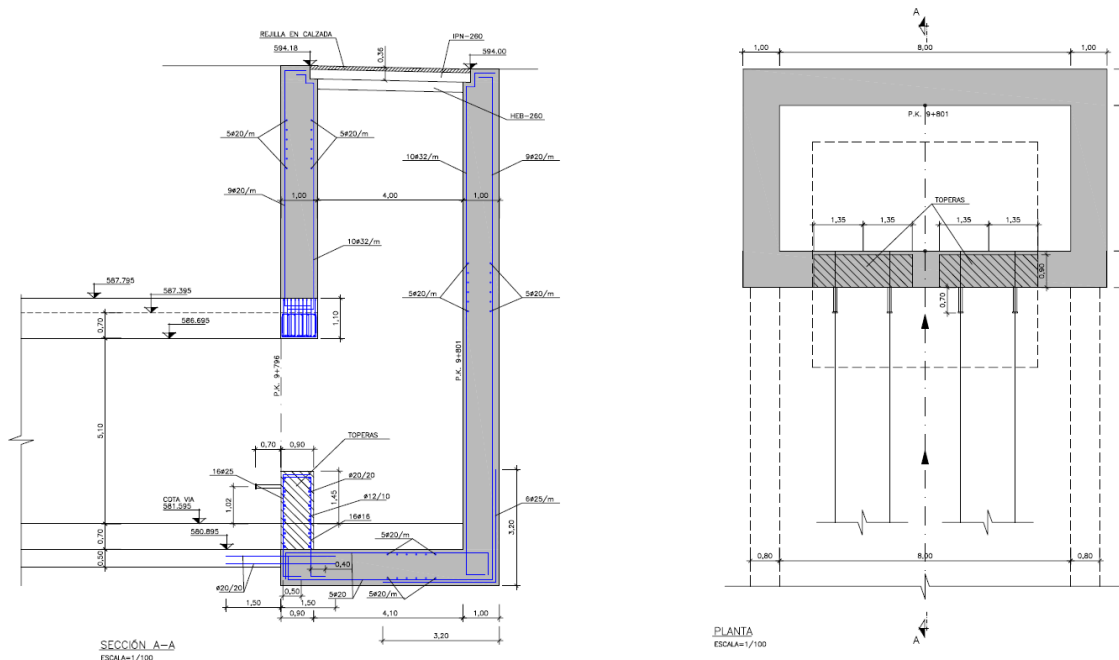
Planta y sección del pozo de compensación (Liquidación del Proyecto Complementario del Proyecto de Construcción de la prolongación de la línea 7 de Metro de Madrid a Coslada y San Fernando de Henares)
